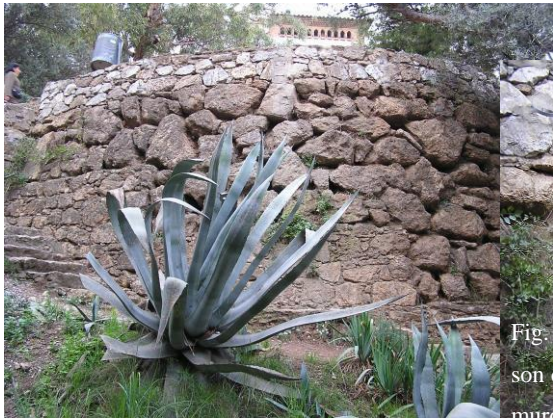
Las aguas infiltradas en el ensanche de la vía son conducidas, gracias a un elaborado trabajo en la obra del muro, alternando juntas secas e impermeabilizadas, a escaleras conectadas al muro.
